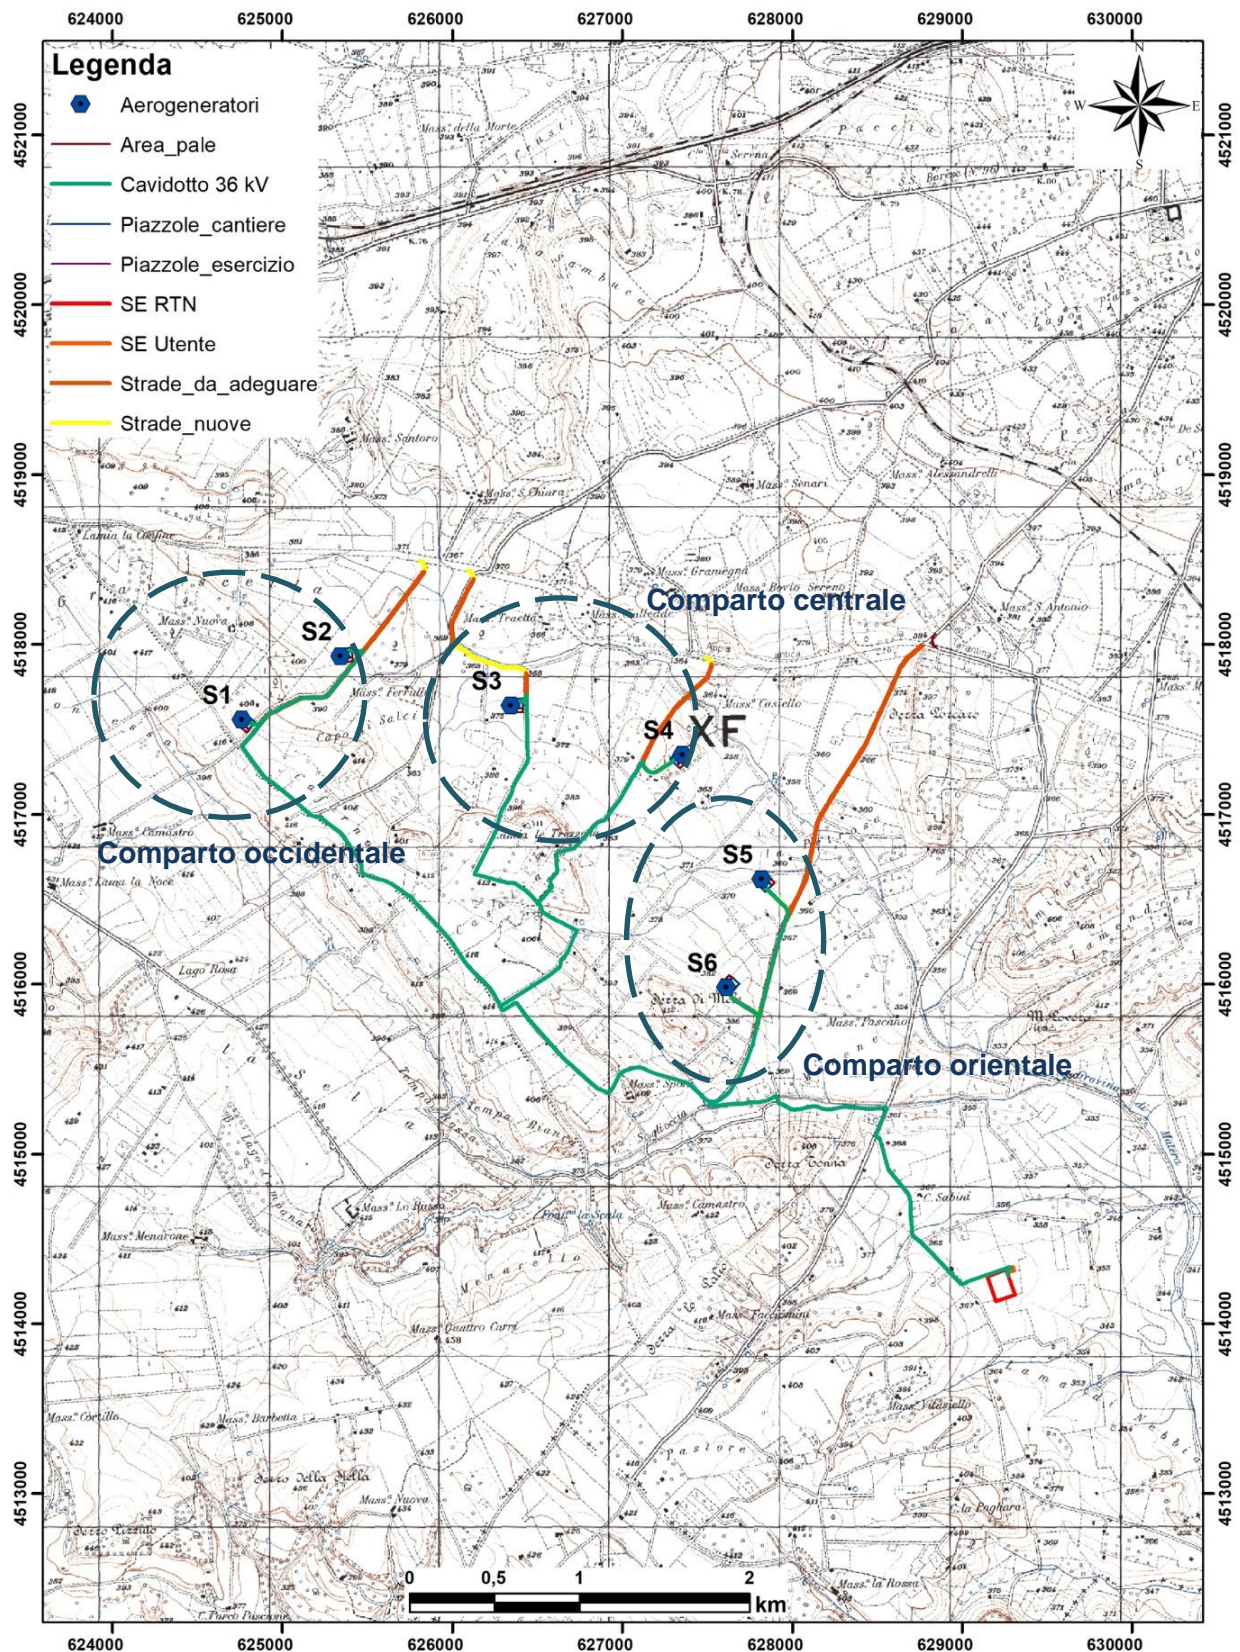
Schema planimetrico del progetto su stralcio I.G.M.I.
